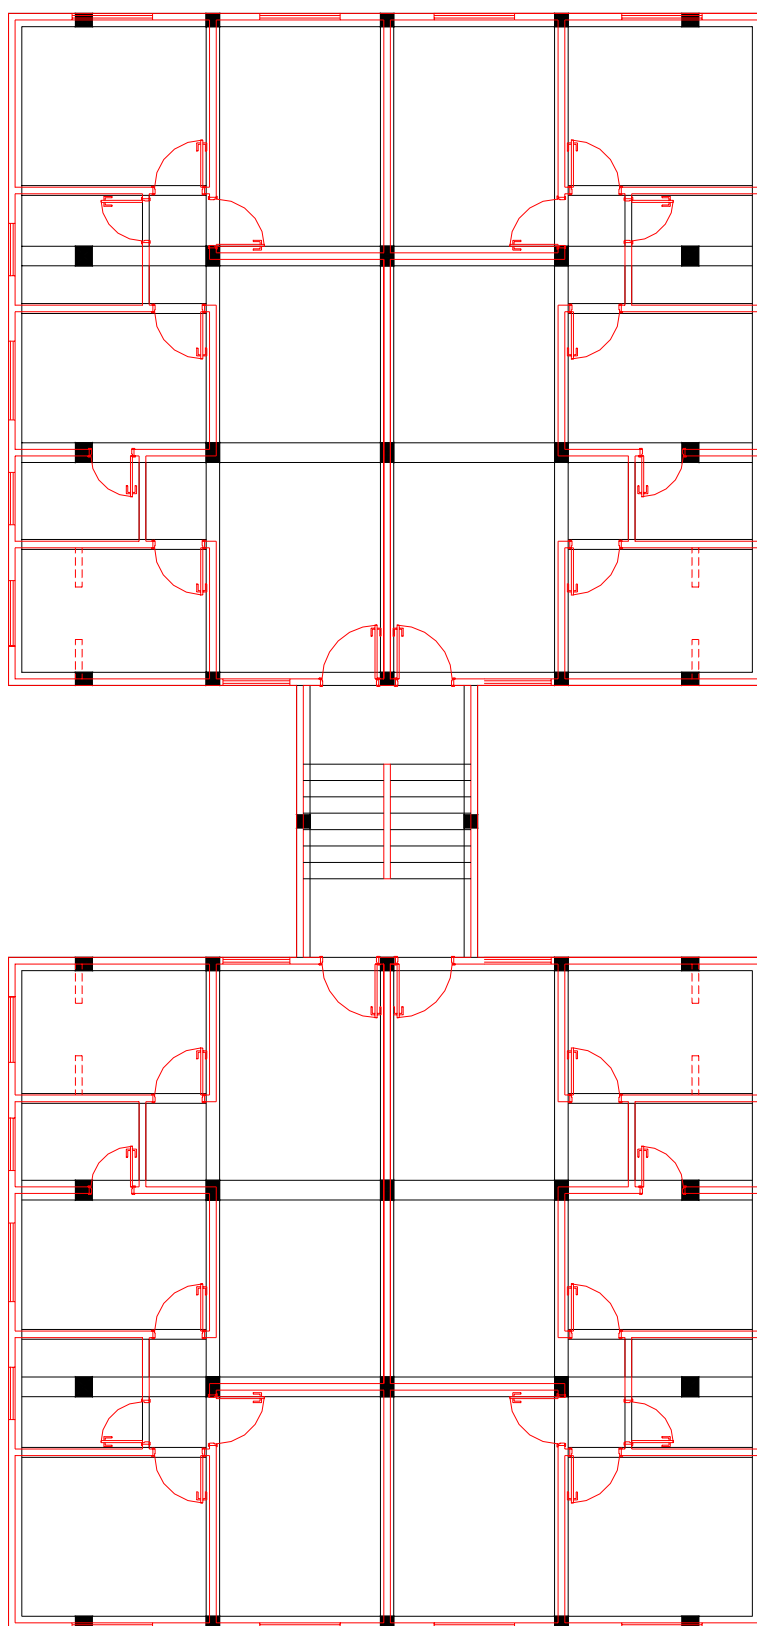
Residencial “G” – Superposição das alvenarias do pavimento tipo sobre a estrutura
